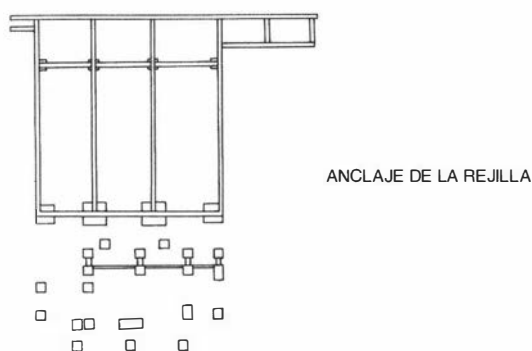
Planta general de la estructura metálica de cobertura del área de excavación.
